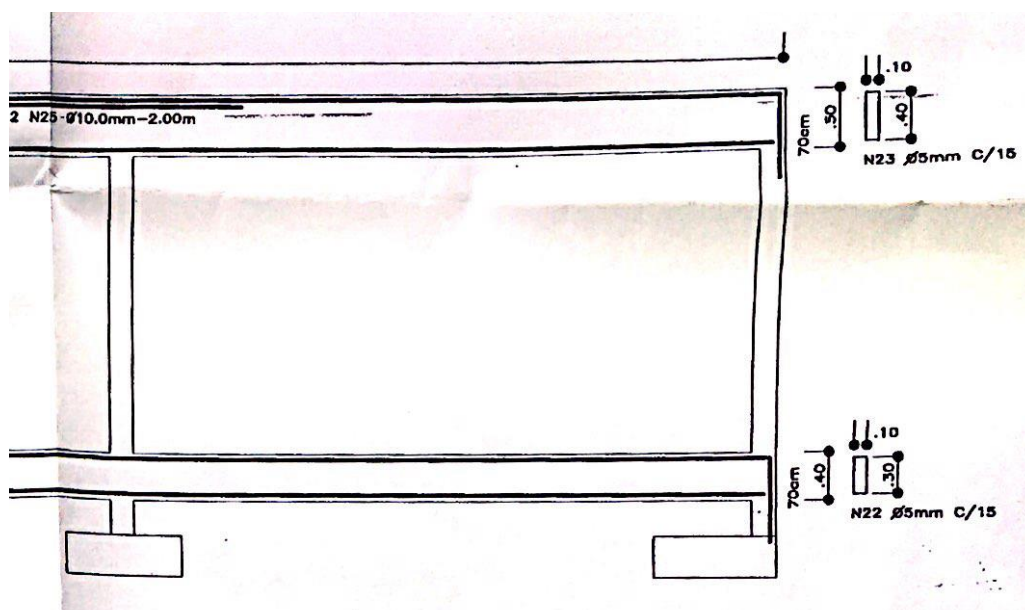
Det. Ampliado do projeto estrutural - Sapata de borda - Corte
